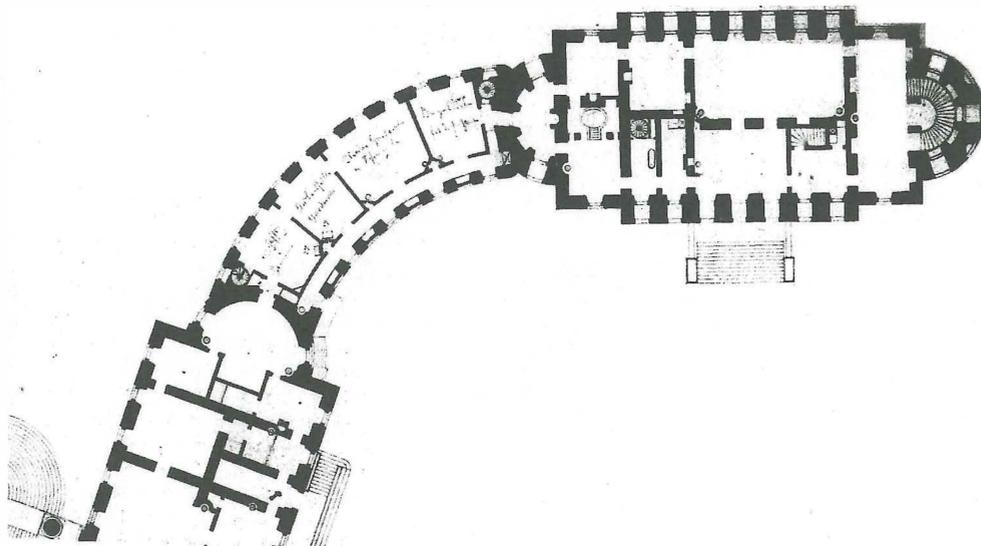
Schloss Wilhelmshöhe, Kassel, Grundriss Erdgeschoss, Zustand nach 1830.
